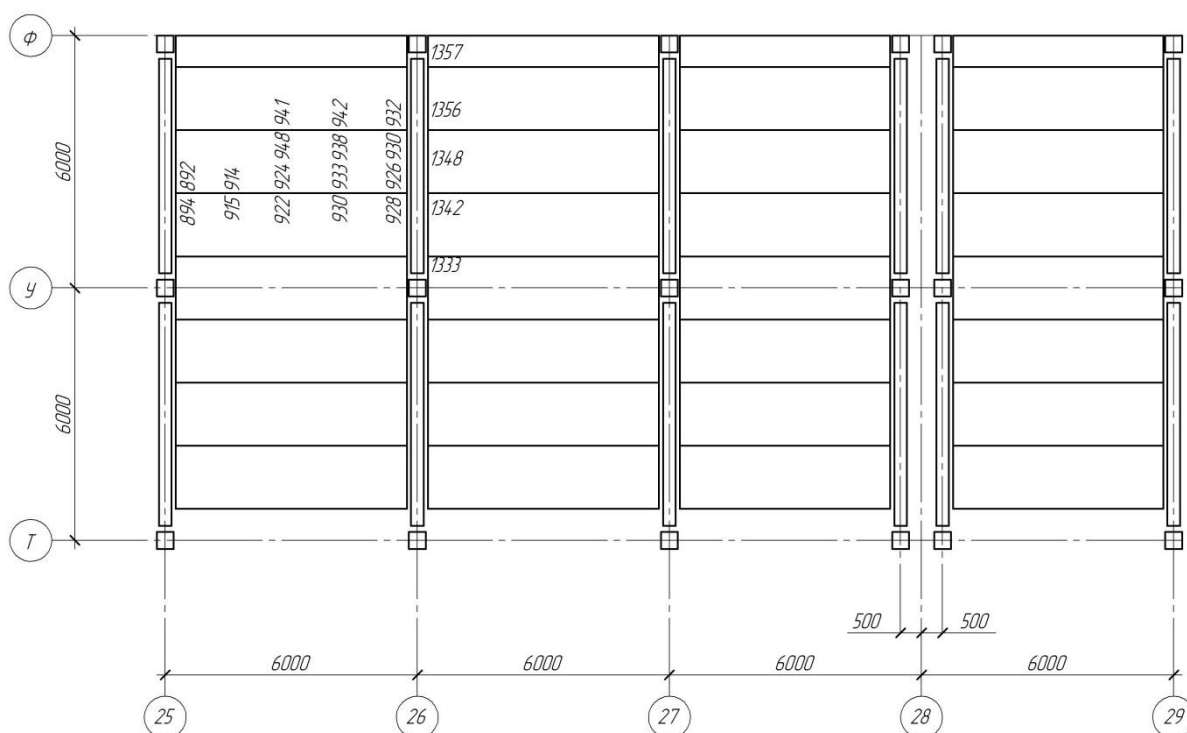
Схема определения прогибов конструкций перекрытия на отм. +4.200
